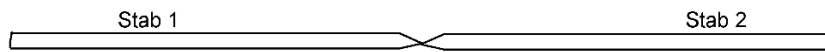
Prinzip der Vorbereitung einer Stumpfschweißverbindung zweier Betonstahlstäbe
